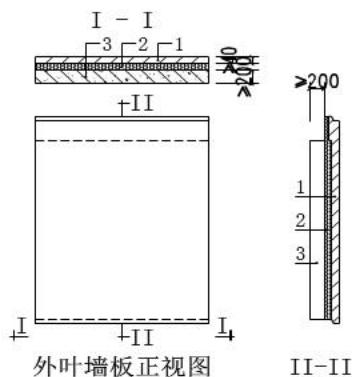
预制混凝土夹心保温外墙板构造示意
